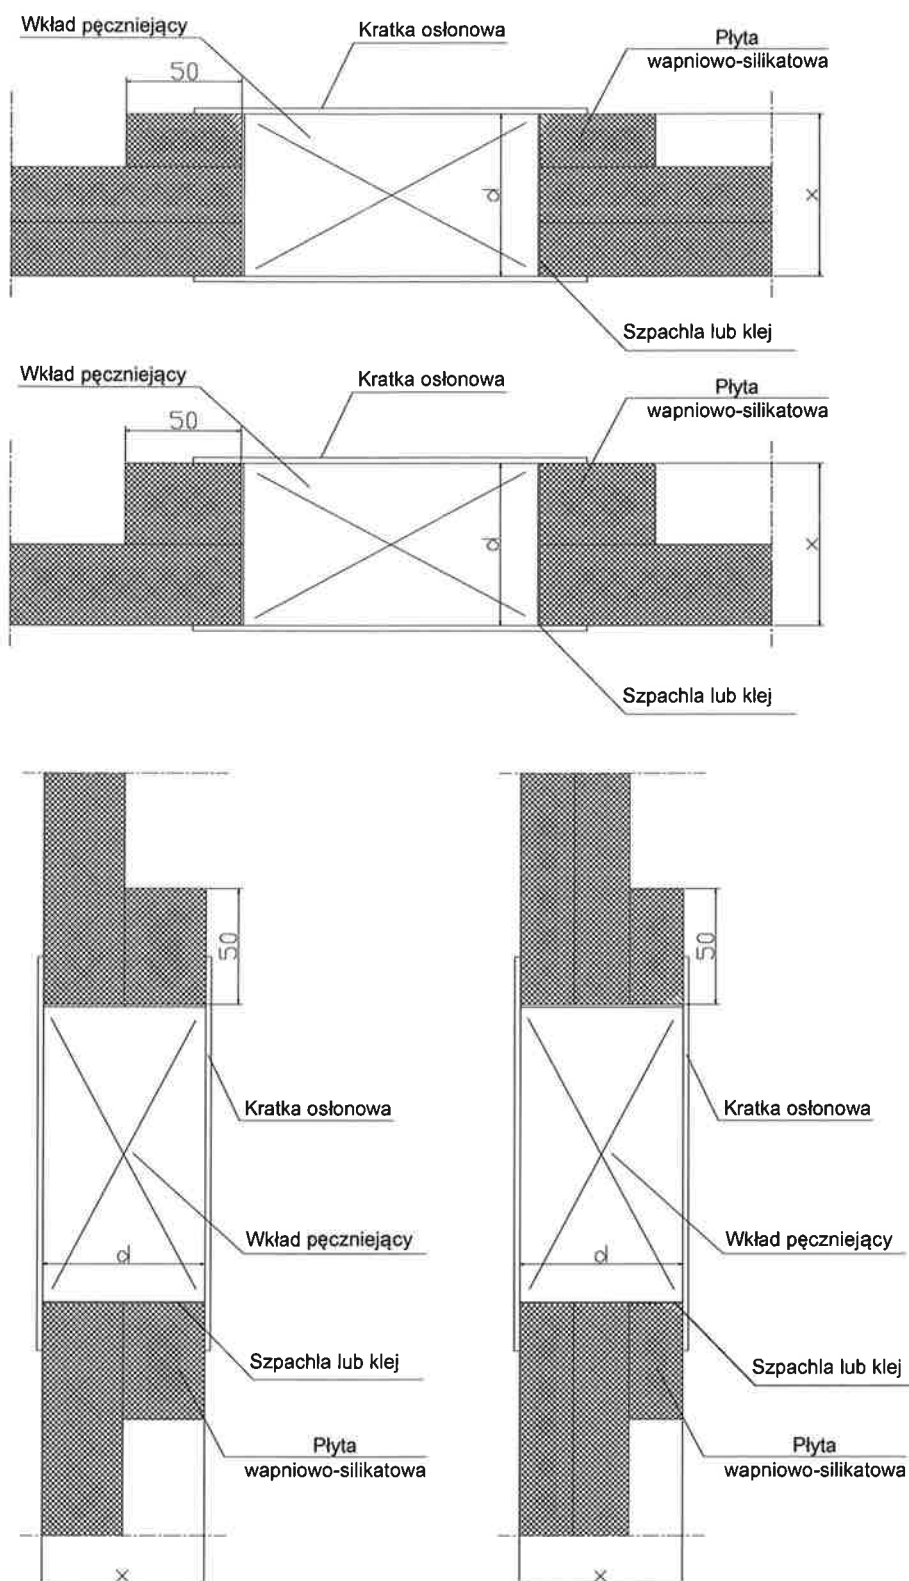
Montaż kratki wentylacyjnych PX-G w przegrodach betonowych lub murowanych
